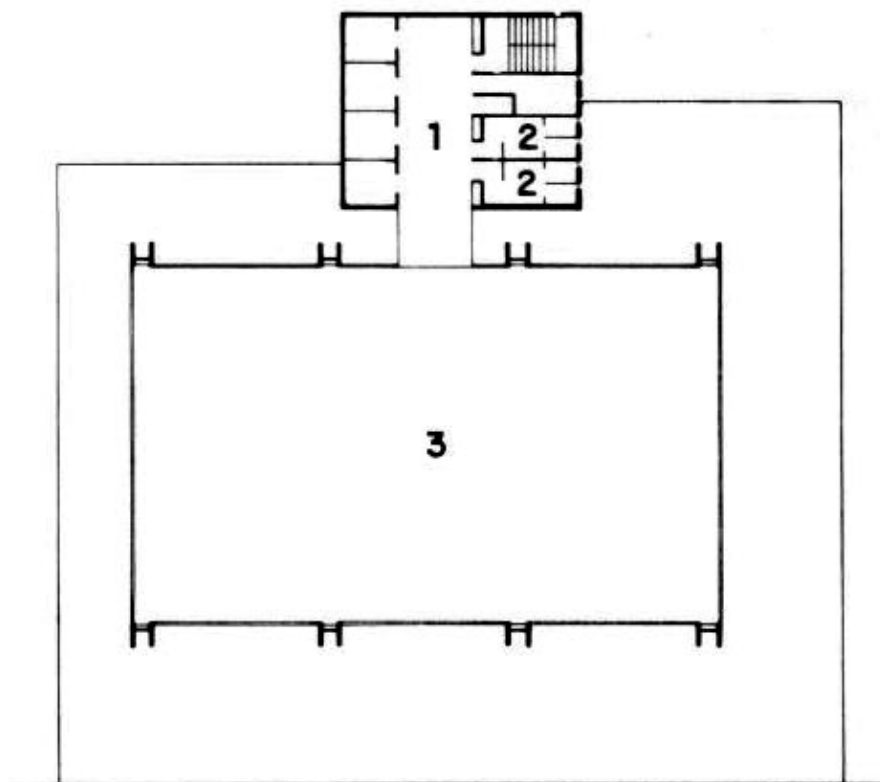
Edifício-sede da Montepar: planta pavimento tipo: 1) hall elevador; 2) sanitários; 3) salão.
